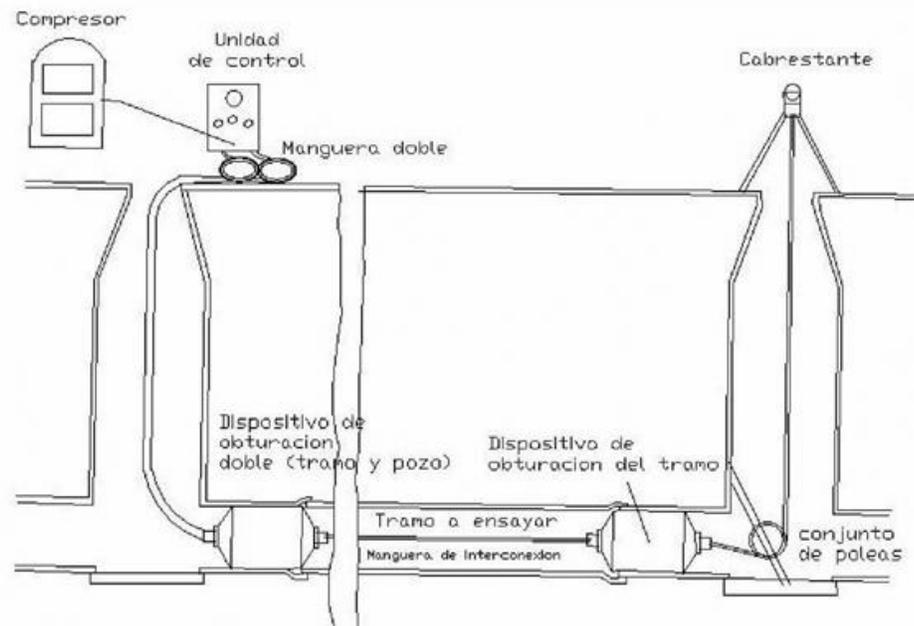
Prueba de baja presión en un tramo de alcantarilla entre dos pozos de registro.
